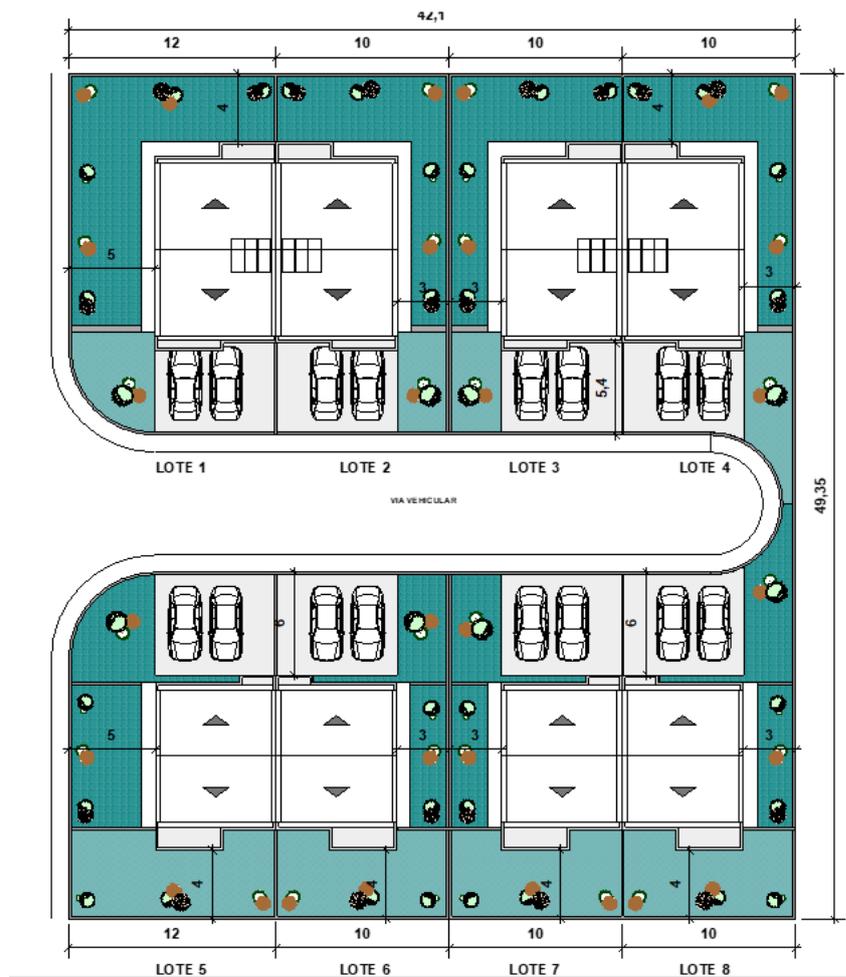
Plano 1 Área del terreno y emplazamiento de las casas. Fuente: Construvicor Cia. Ltda.
